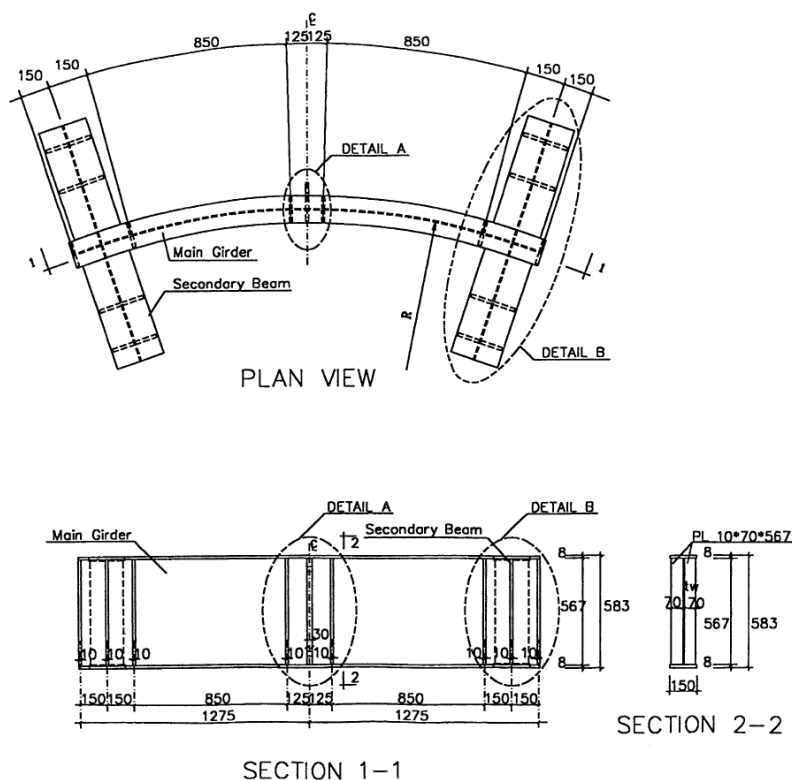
Detalhes do plano e da seção transversal da viga principal.
